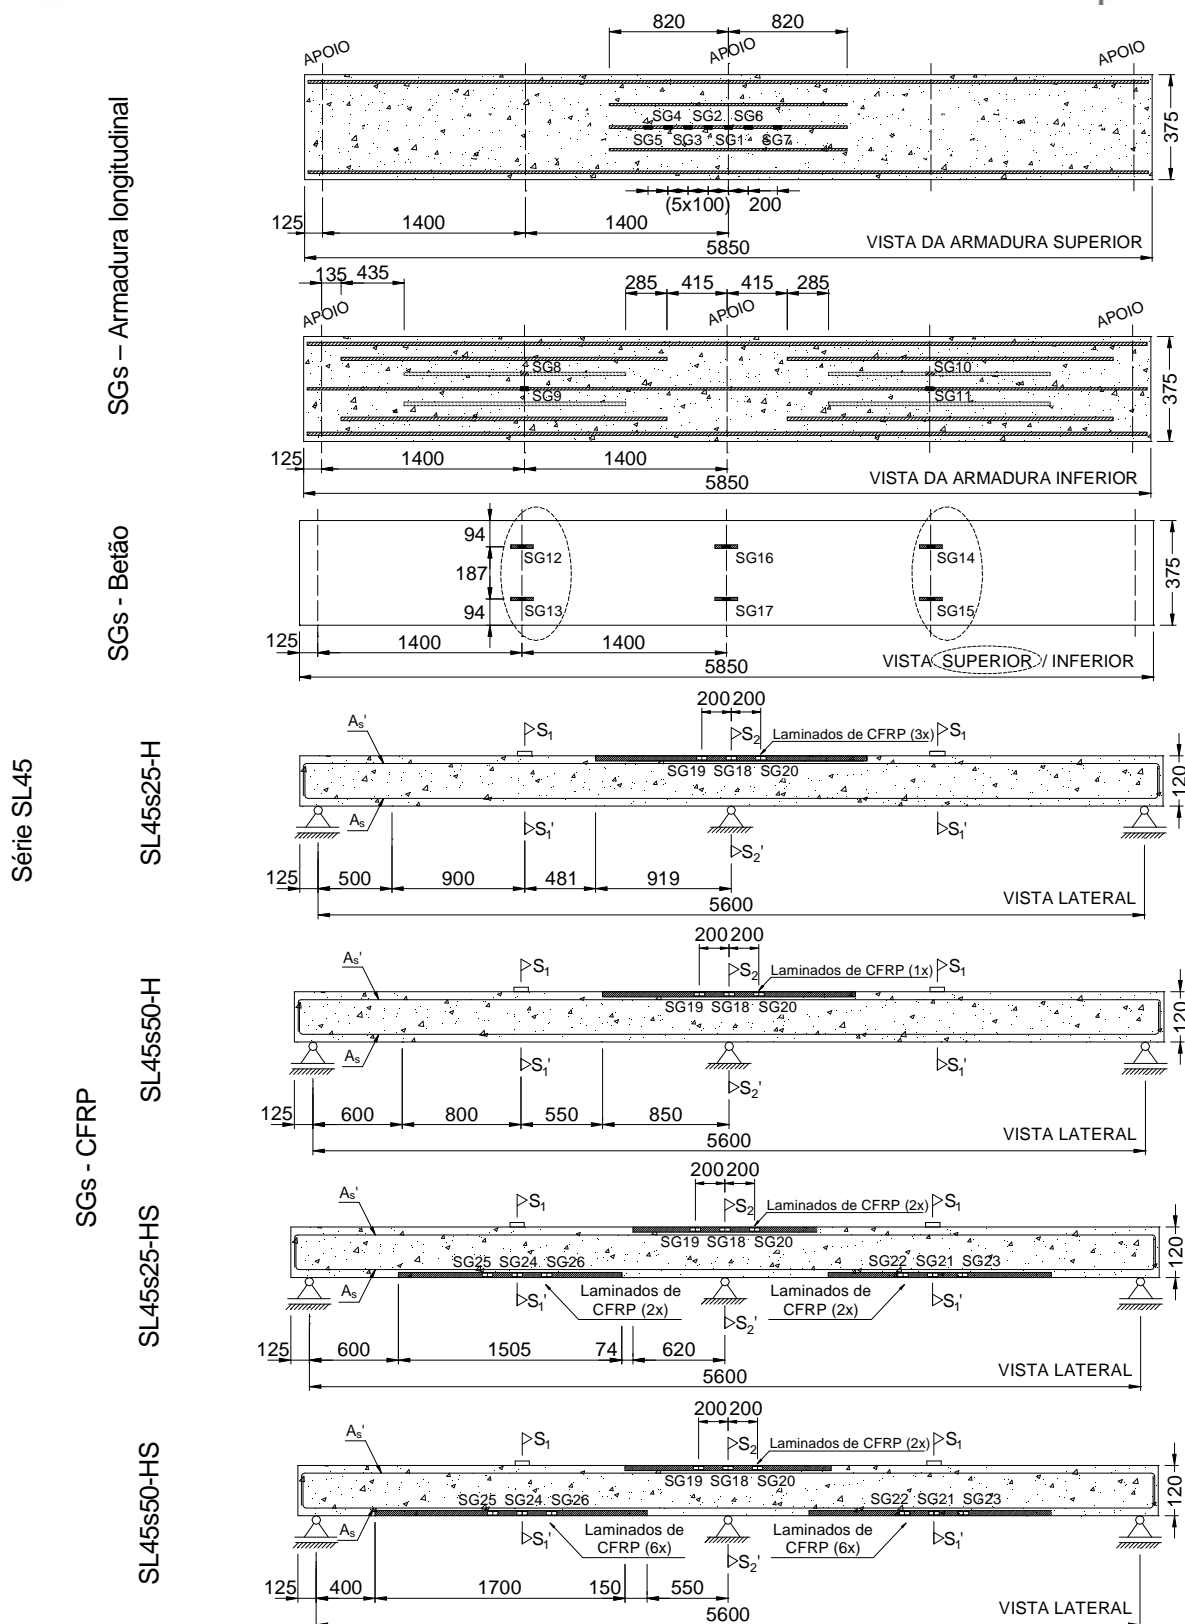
Posicionamento de (a-b) extensômetros nas armaduras longitudinais, (c) betão, (d-g) laminados de CFRP para as faixas de laje reforçadas da série SL45 (dimensões em mm).
